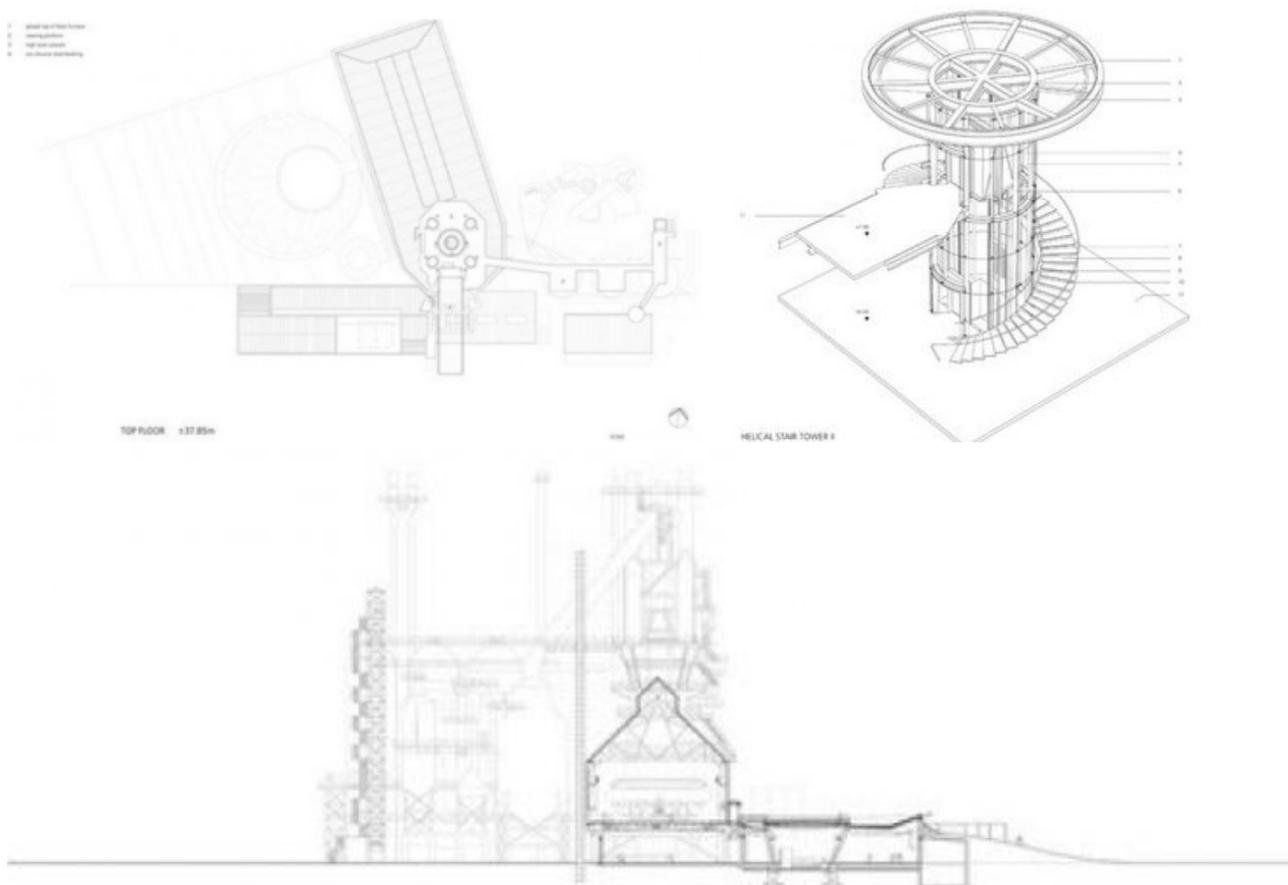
3-4-5: Disegni architettonici: pianta coperture, scala , sezione
